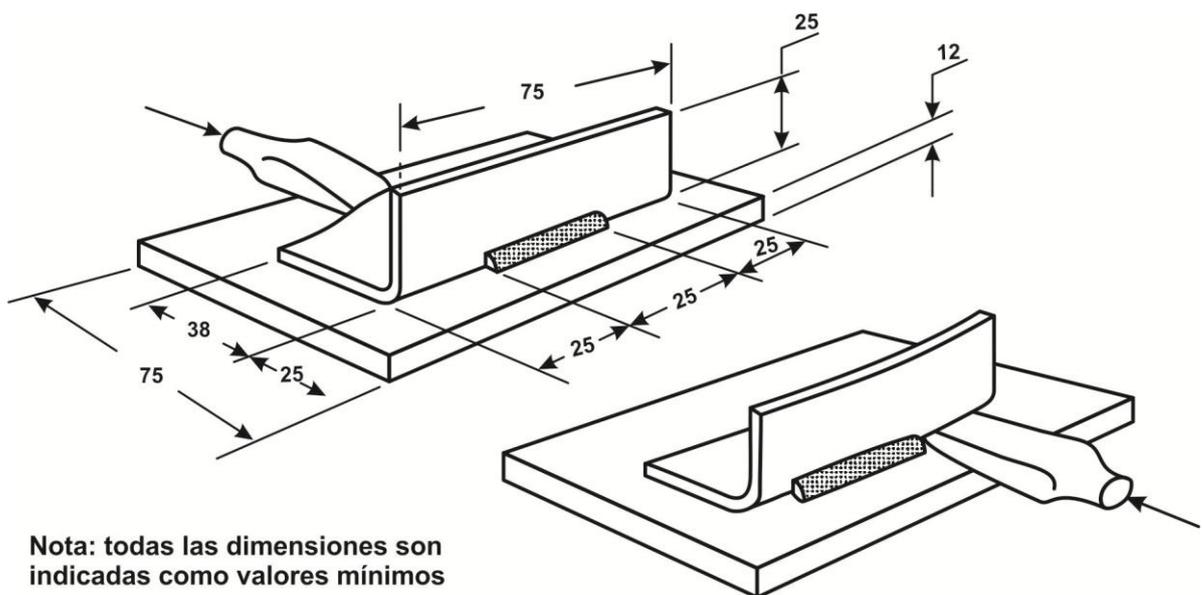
b). Esquema de ensayo para soldaduras entre chapa y elemento estructural portante con junta acampanada simple.
